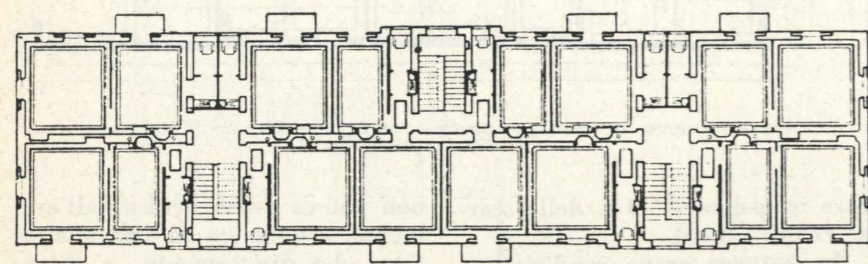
Progetto 2° classificato: pianta - tipo di un edificio a 3 scale e 10 alloggi per piano.
